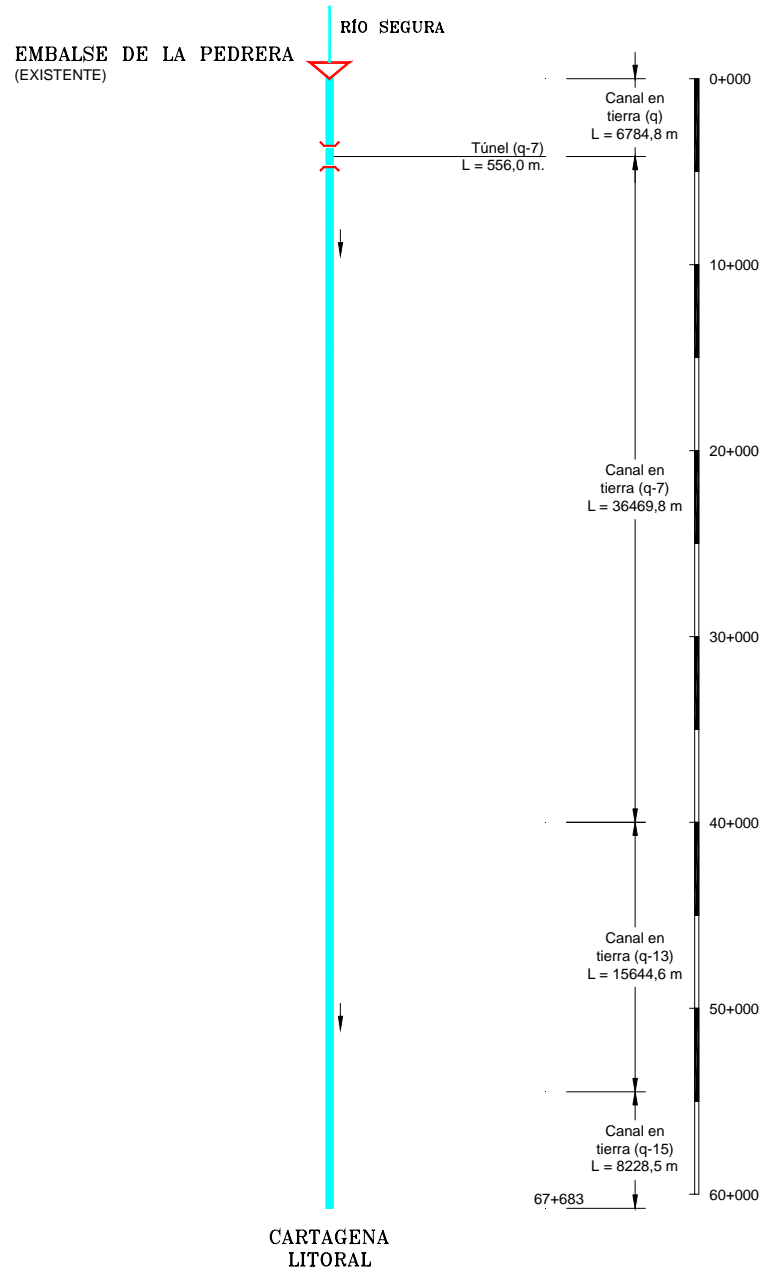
Conducción Bajo Segura-Cartagena Litoral. Esquema en planta
